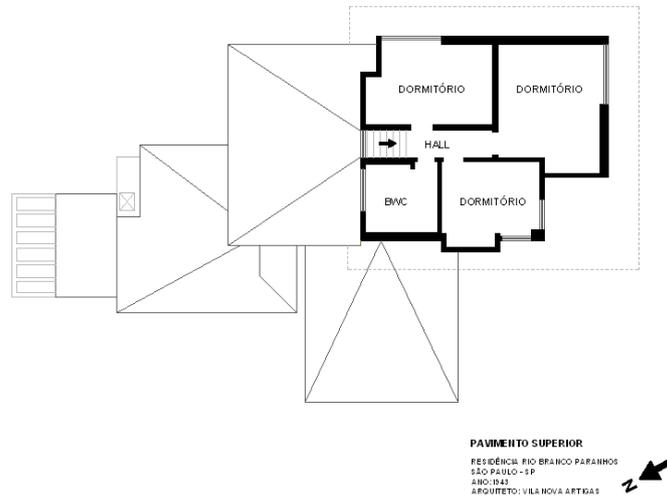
Redesenho da planta baixa superior da residência de Rio Branco Paranhos, 1943.
